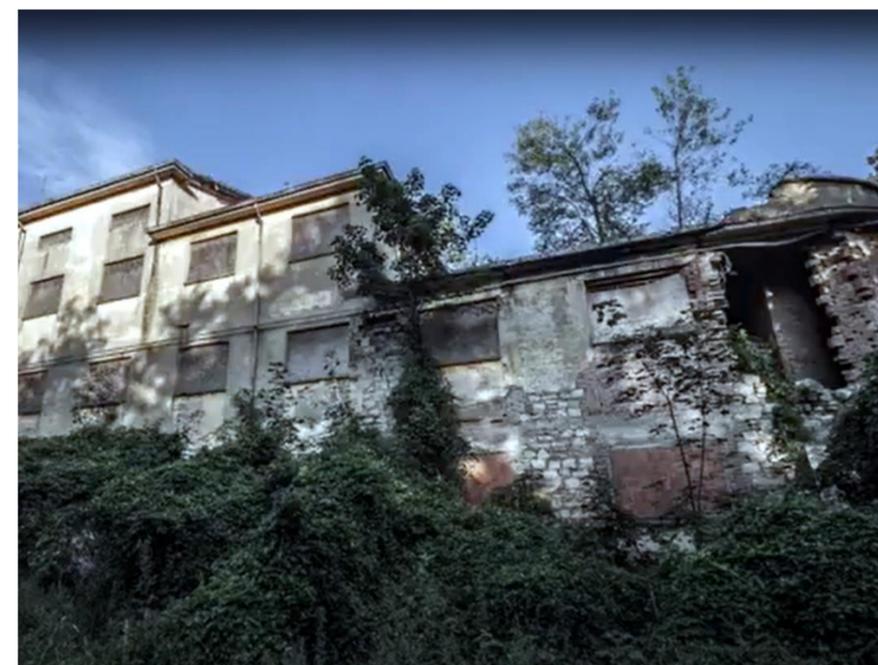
Foto Fonte: @Country_Urbex (<https://www.youtube.com/watch?v=J7Tp8uu-jfg>)
